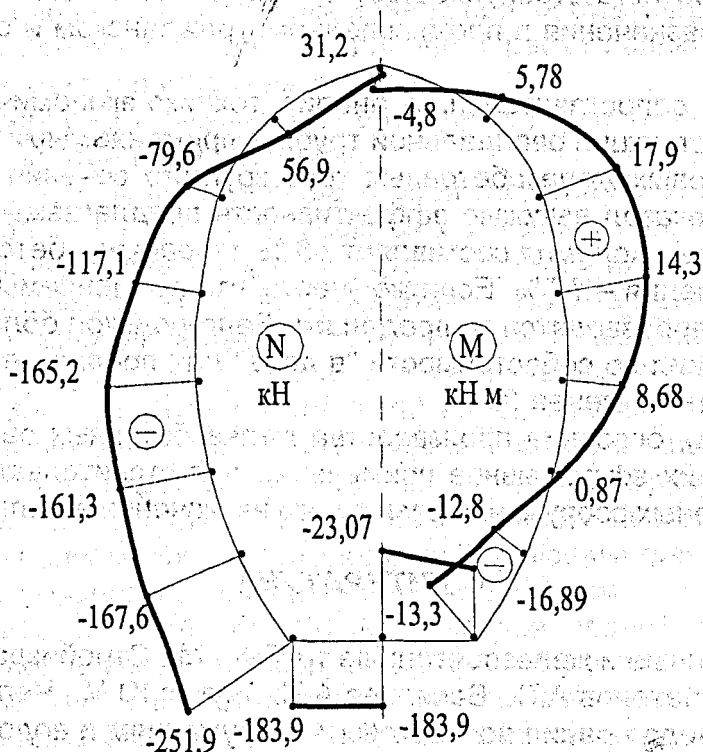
Результаты расчета железобетонной овоидальной трубы
